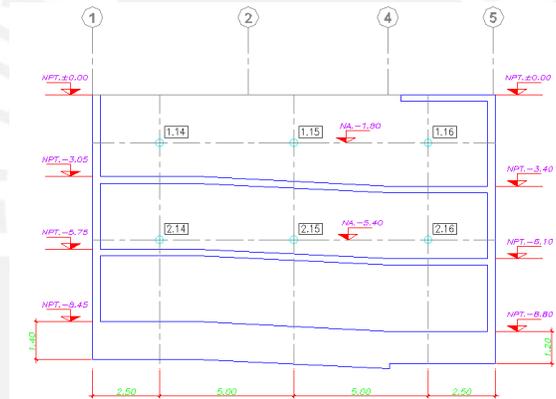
Muros Anclados – Nivel de Cimentación.
